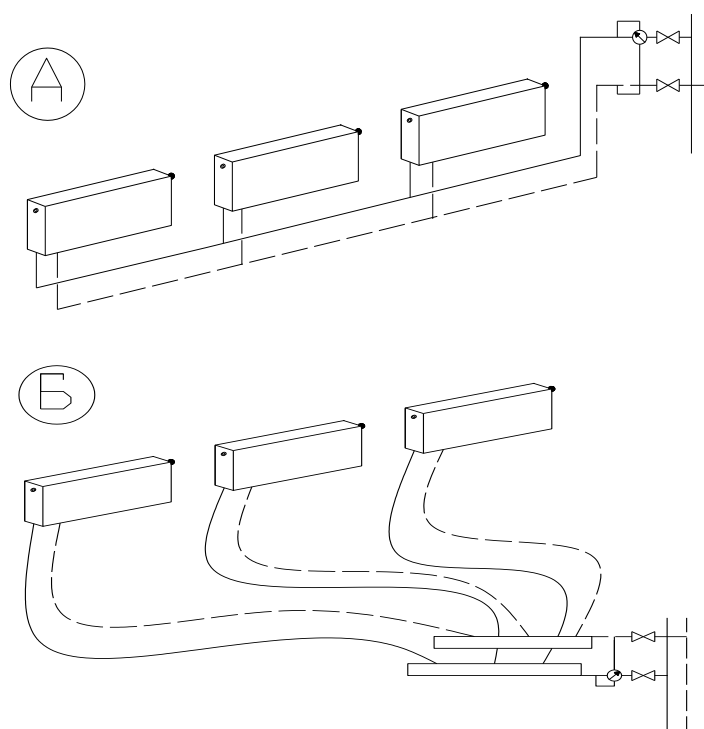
Схемы разводки трубопроводов квартирных систем отопления:
